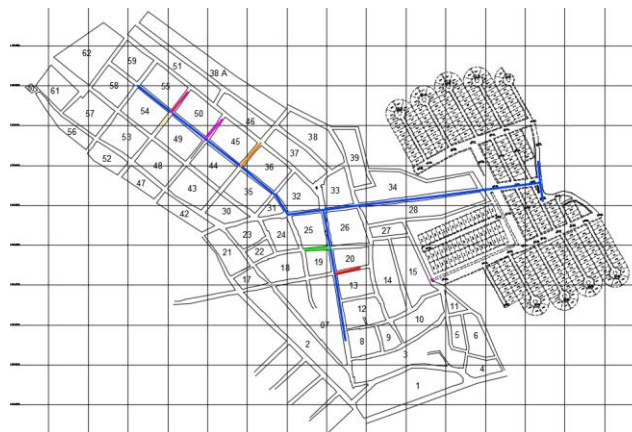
Planta do novo loteamento. Fonte: Autoral Autocad
